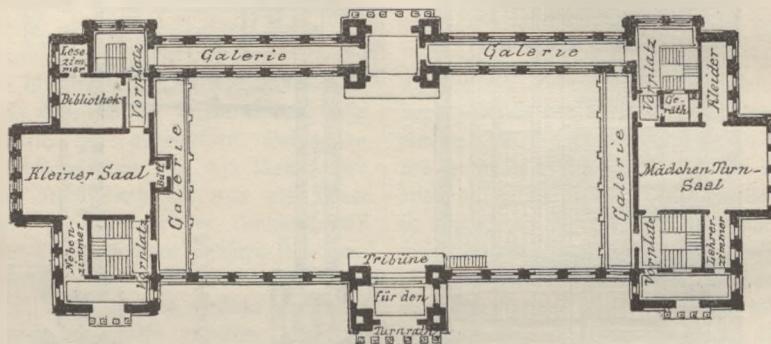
Grundriss des oberen Stockwerkes.
